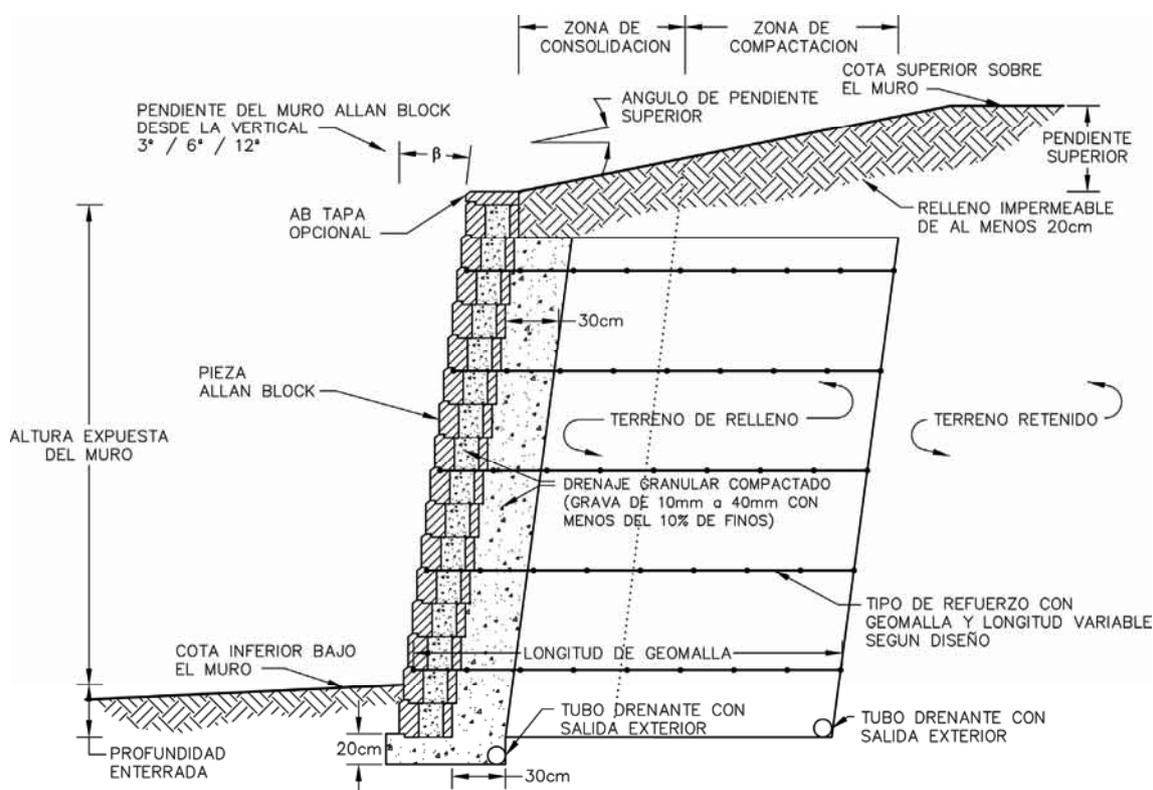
Muro de sillares de hormigón tipo Allan Block para contención de tierras. Ejemplo de muro reforzado mediante tirantes.
